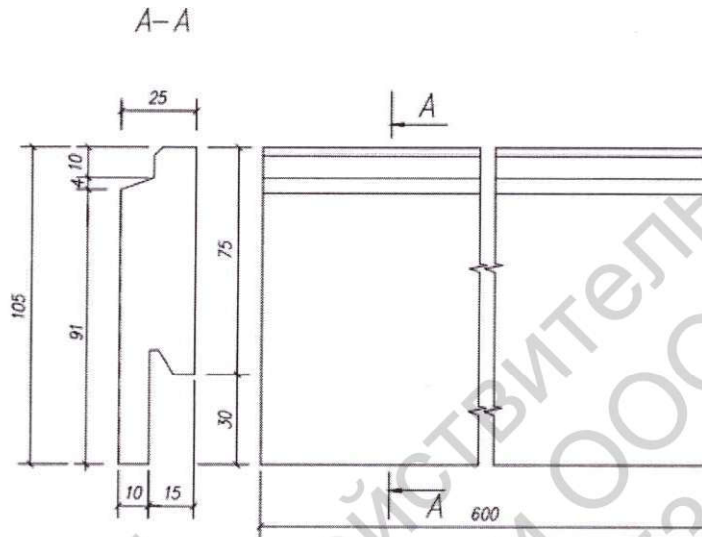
Общий вид и профиль поперечного сечения плитки «ФРОНТ'ОН»
